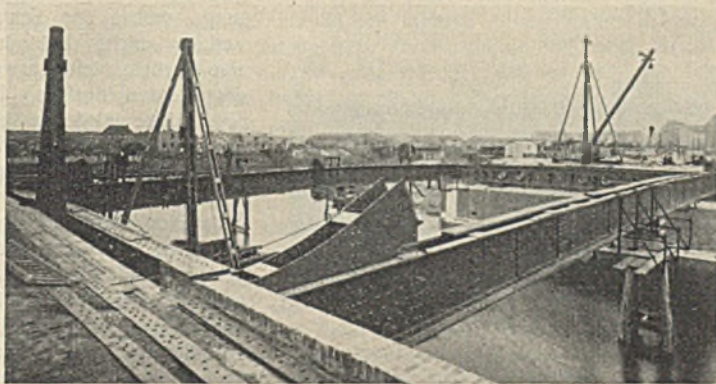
Billekanal-Brücke; Montage der Querträger.
